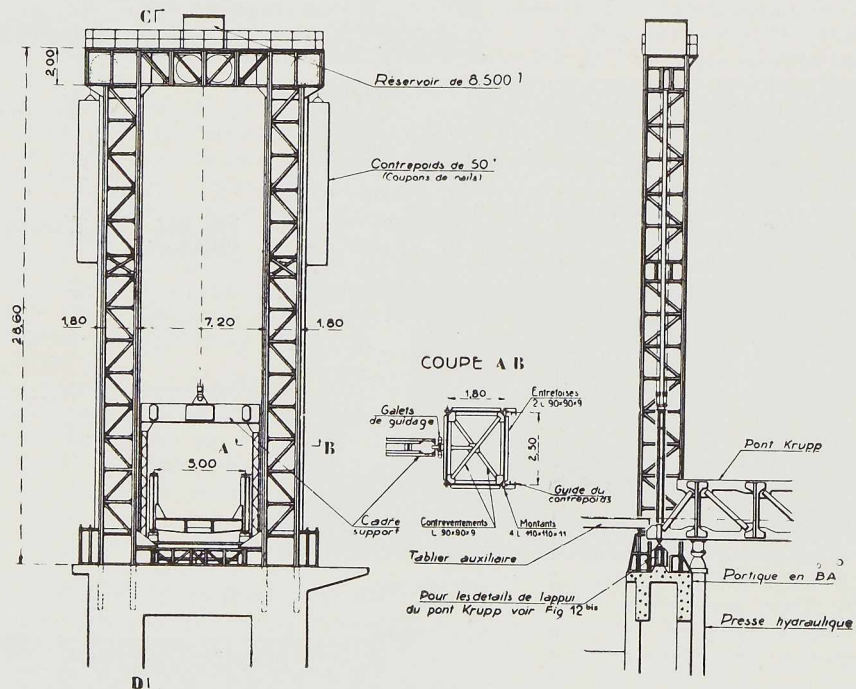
Détails des supports de la travée levante provisoire du viaduc de Caronte.
